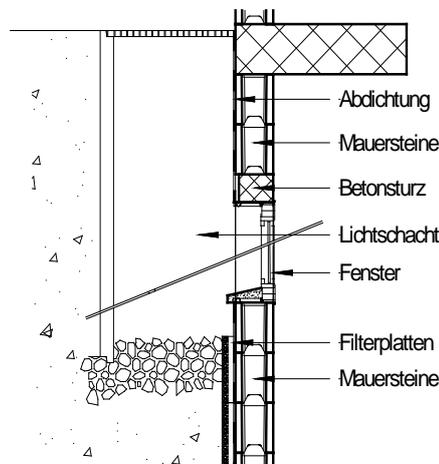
Querschnitt: Kellerwand mit Fenster und Betonsturz
